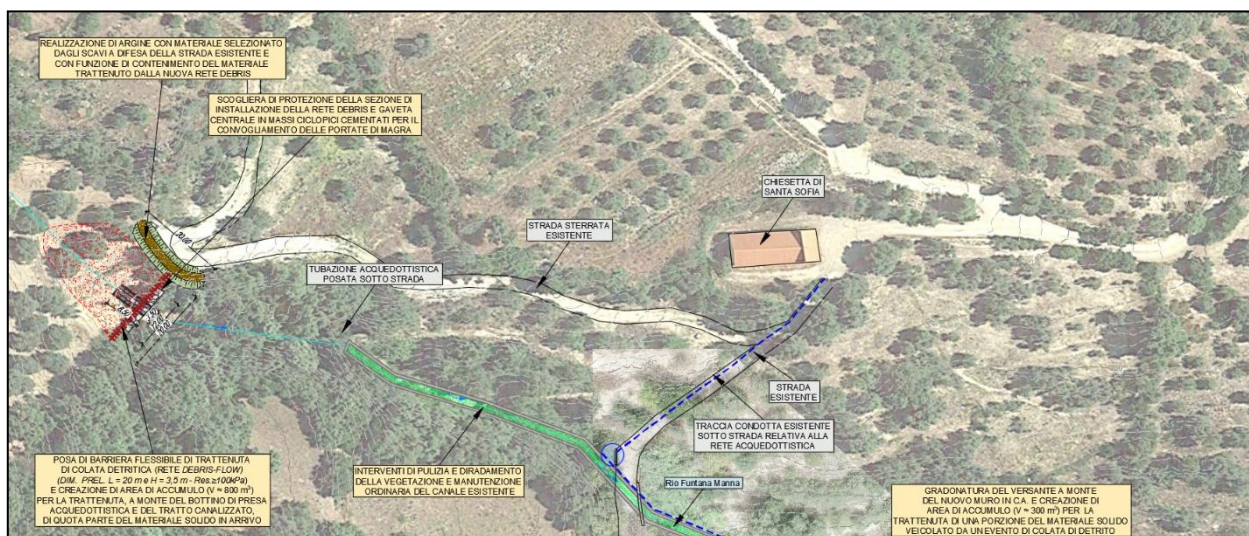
Dettaglio della planimetria interventi sul rio Funtana Manna – Intervento di monte
